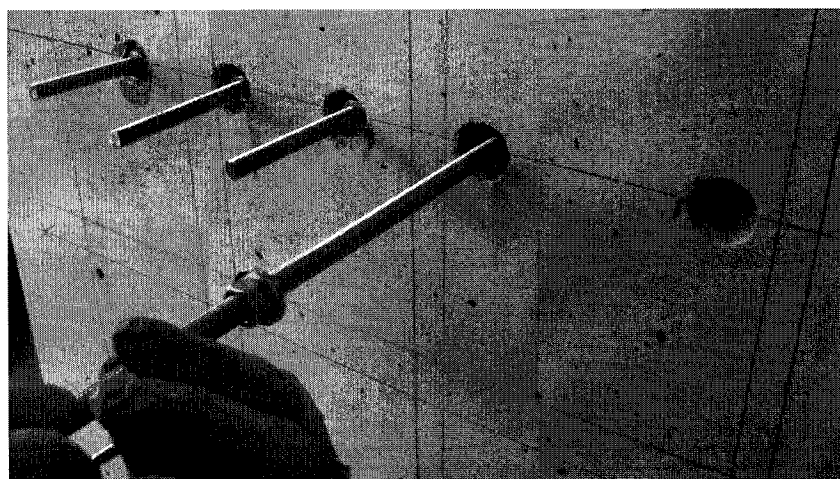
Photo de l'installation d'une tige d'ancrage sur le pilier 4
